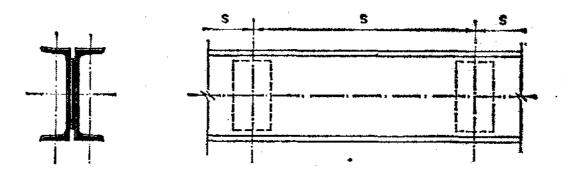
Ejemplo de pieza simple constituída por perfiles y forro discontinuo de chapa
